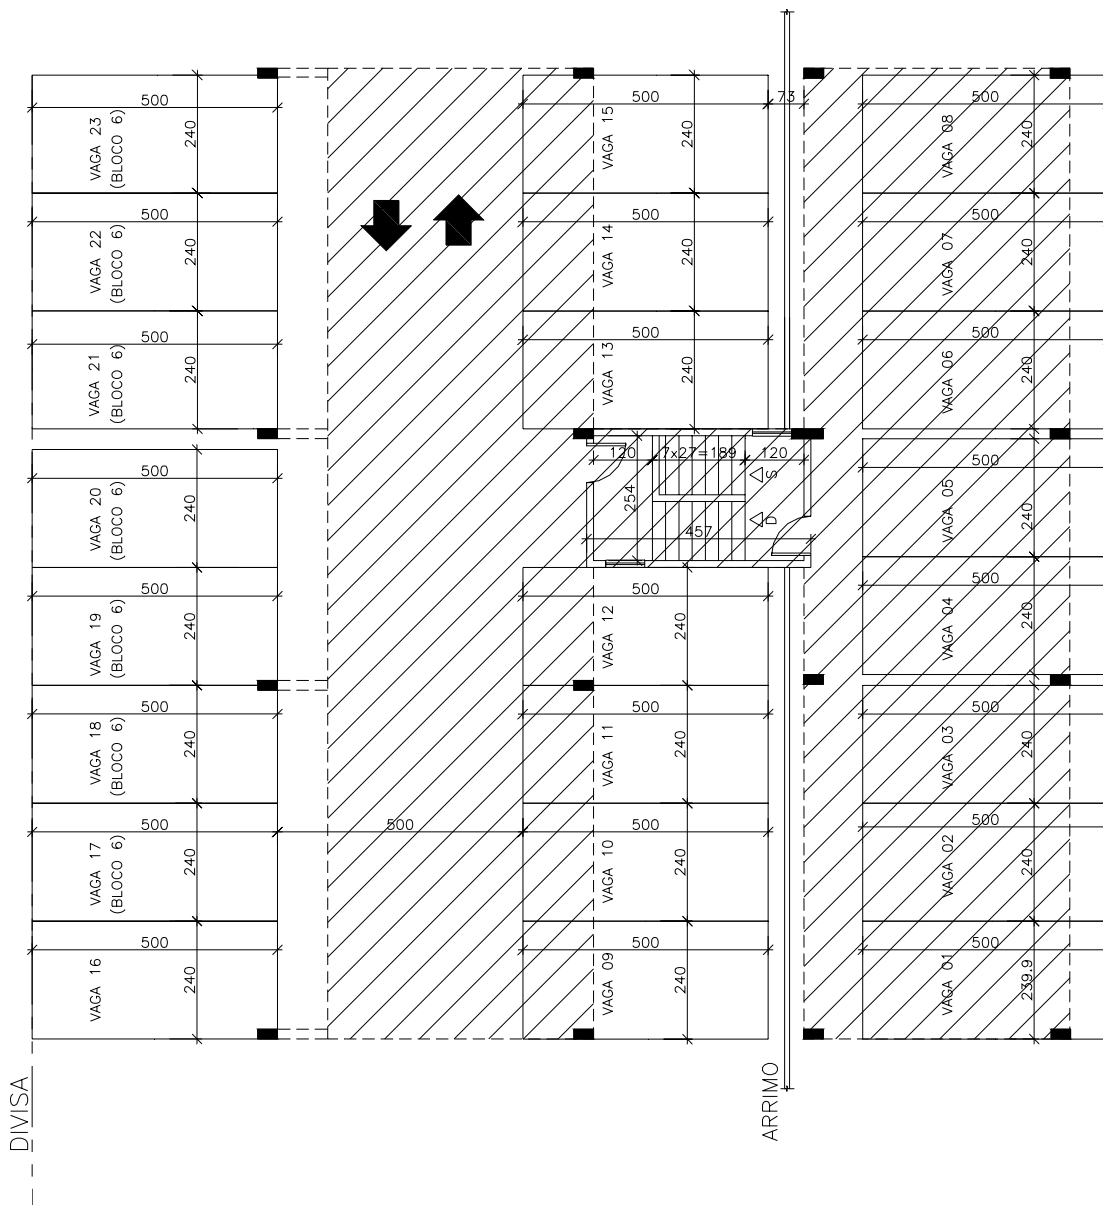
Residencial “J” – Bloco 5 – Projeção do pavimento tipo sobre as garagens
